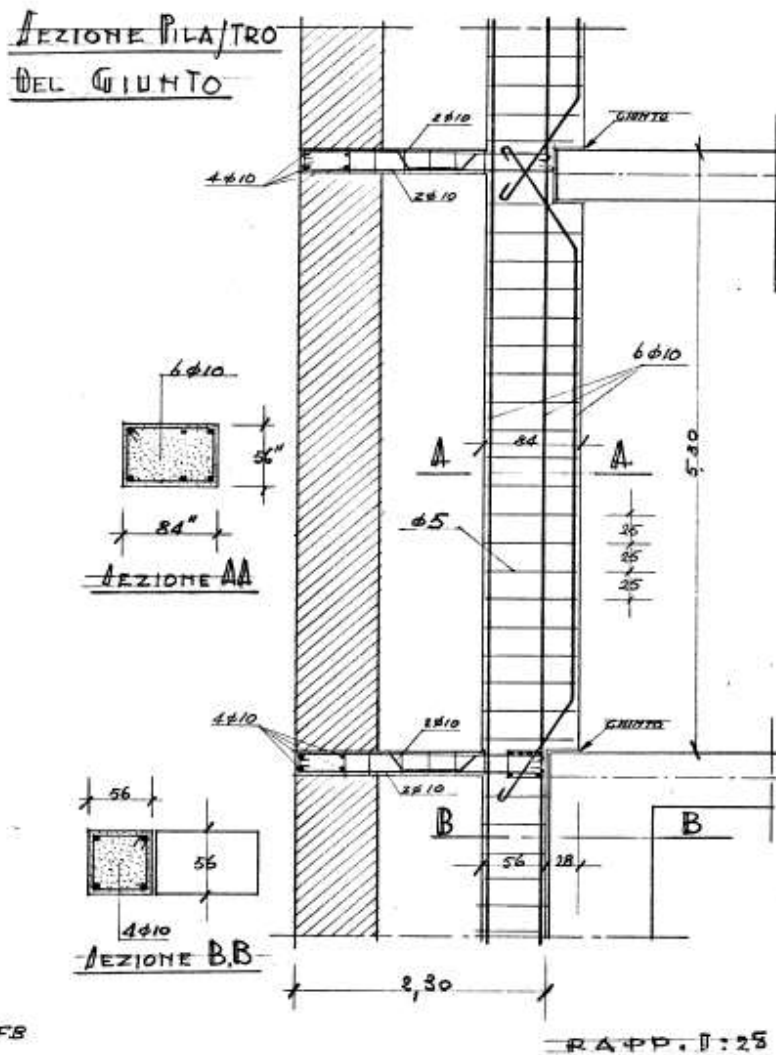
Sezione trasversale del pilastro tra la torre e l'edificio oggetto di indagine (progetto preliminare della torre).
